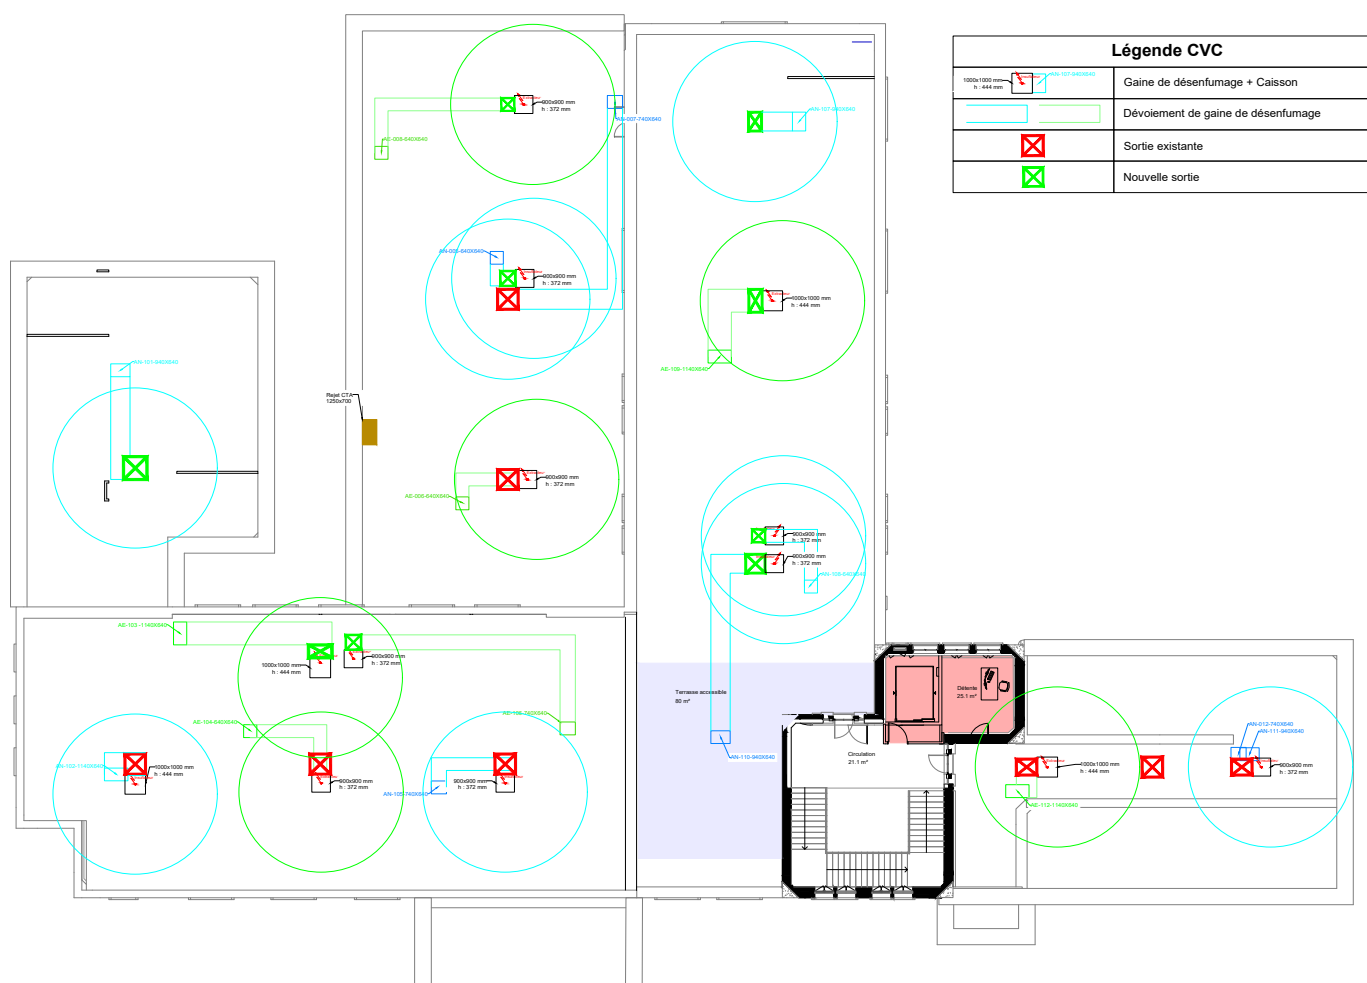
État projeté (APD) des sorties techniques en toitures, plan R+2, pavillon A, BET OXY, 2024.
